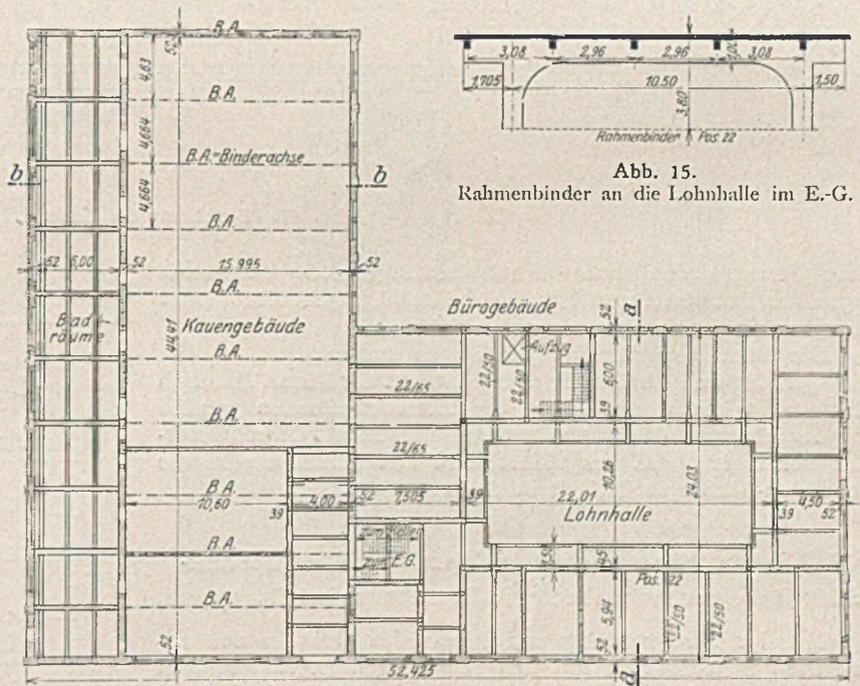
Grundriß in Höhe der Erdgeschoßdecke.
